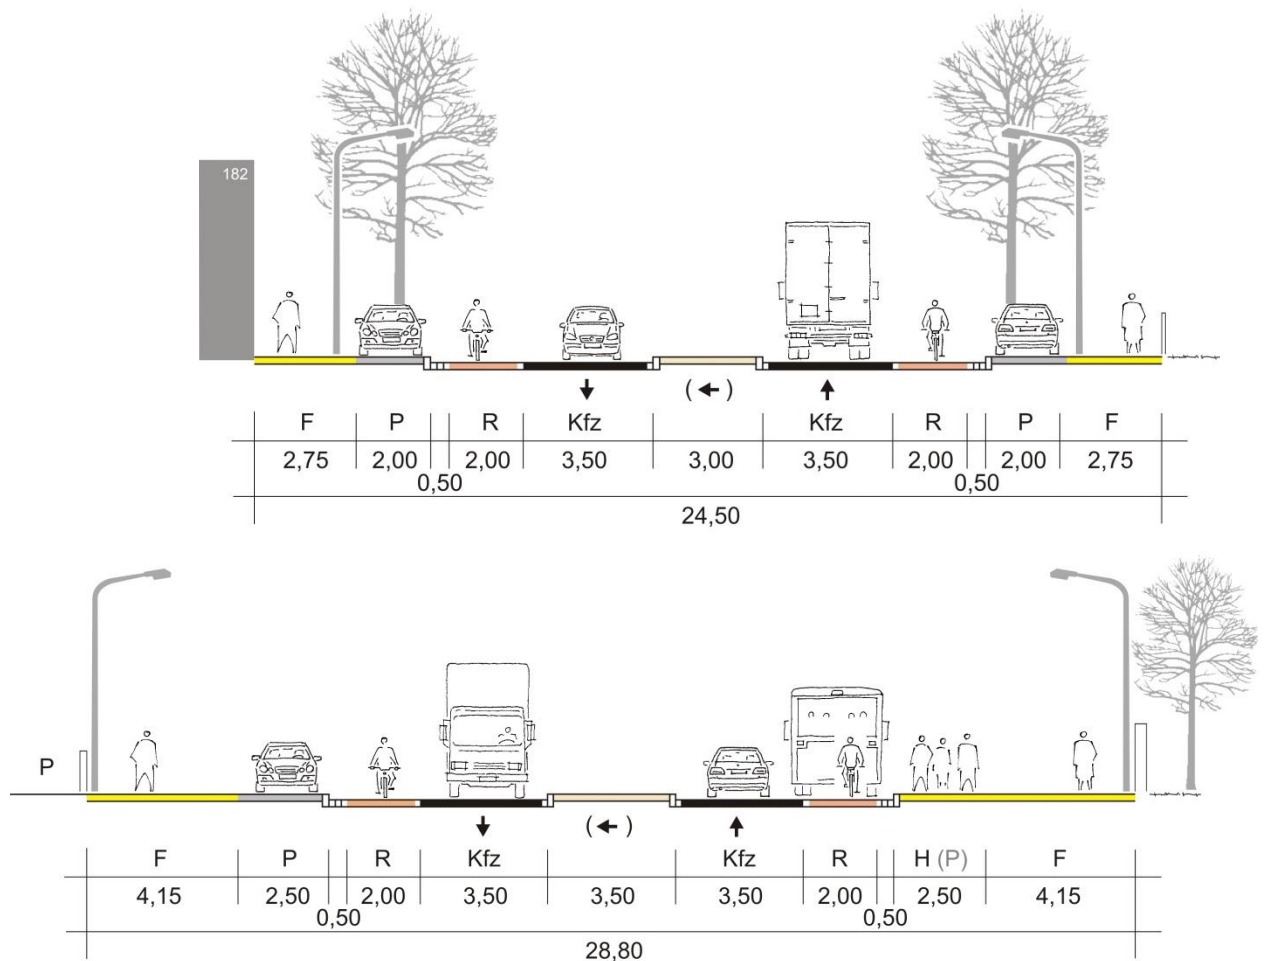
Gestaltungsvorschlag Mindener Straße – Variante 1 für die Straßenraumquerschnitte A-A (oben) und B-B (unten)
